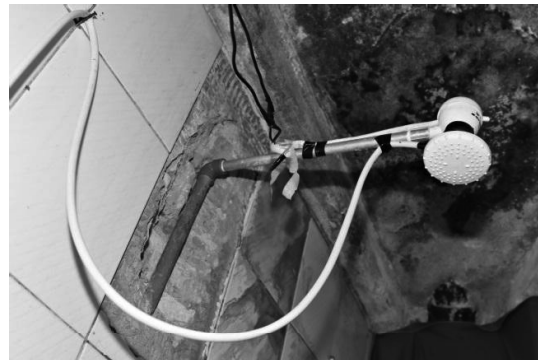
Instalação do chuveiro sem aterramento e infiltração no teto
